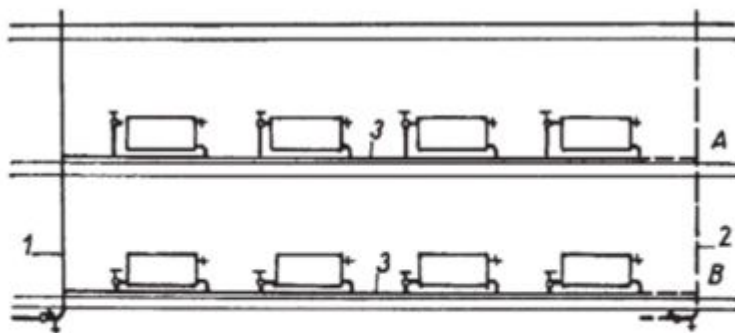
Schéma dvoutrubkového teplovodního vytápěcího zařízení s horizontálním rozvodem
